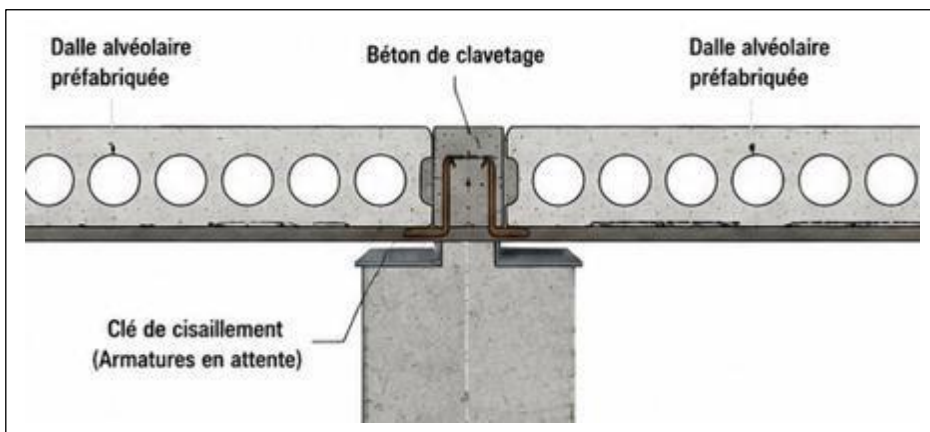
Coupe longitudinale A-A clavetage des dalles alvéolaires.
